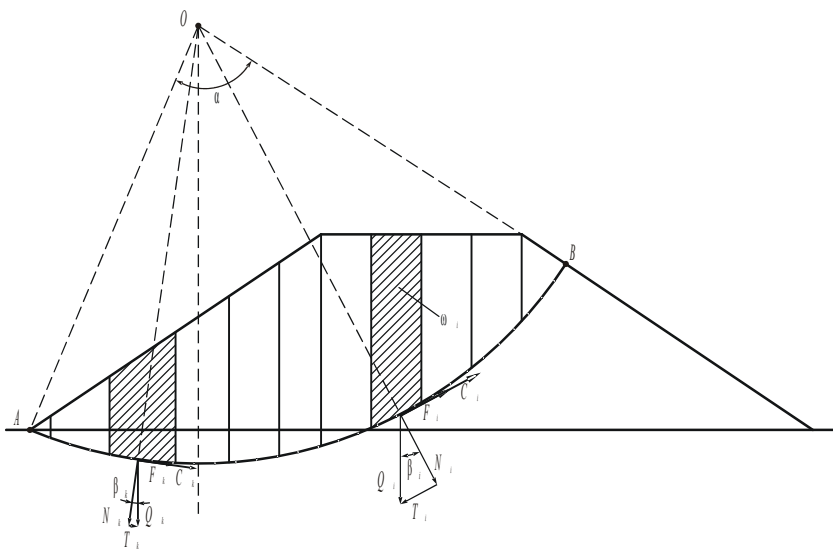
Схема разбивки насыпи из однородных грунтов на отсеки
